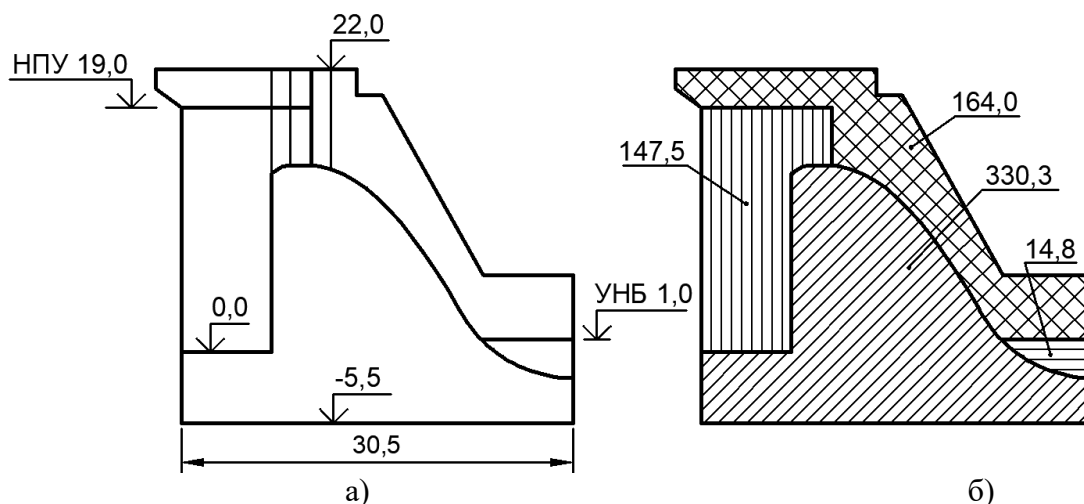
Исходные данные к расчёту нагрузок на бетонную водосливную плотину
